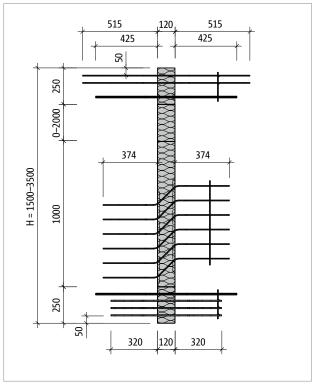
Schöck Isokorb® XT Typ W-M4: Produktgrundriss
